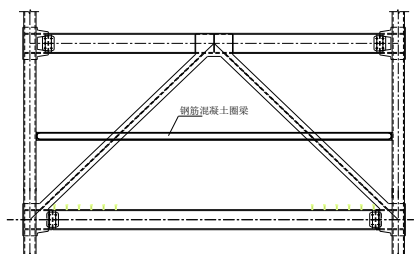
钢筋混凝土圈梁用于减小支撑计算长度
